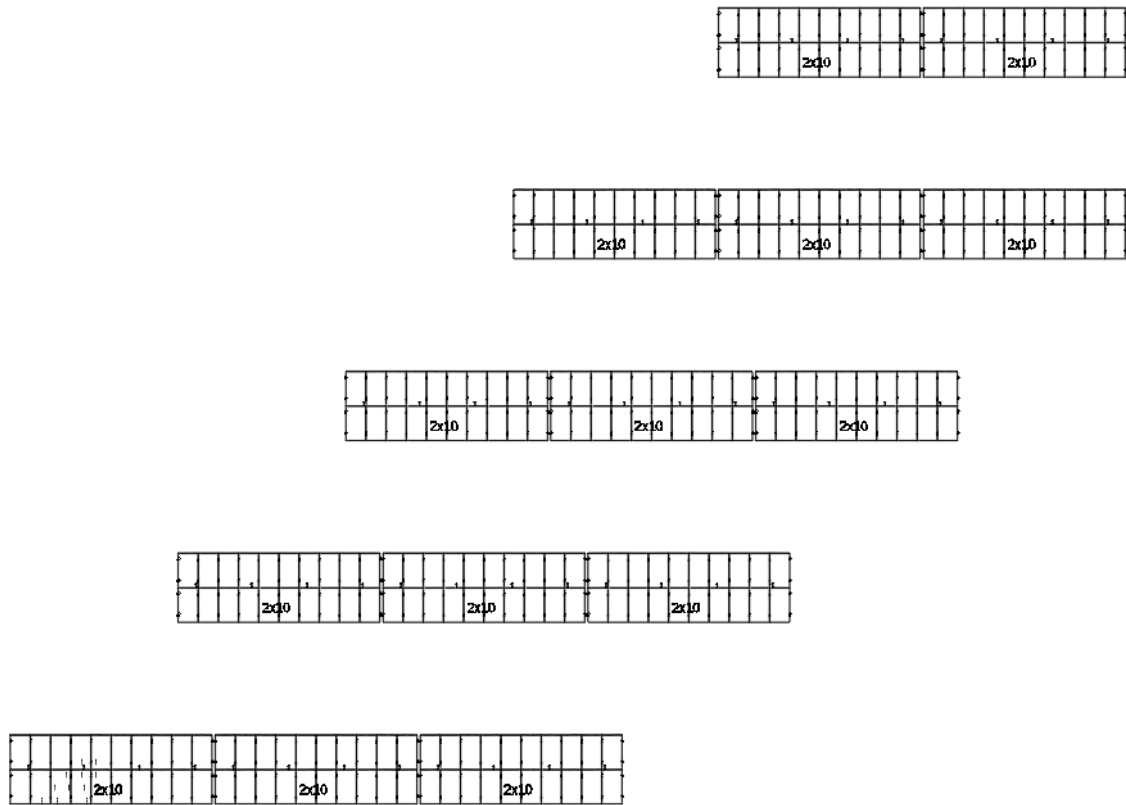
Planta estrutural do parque de painéis fotovoltaicos
